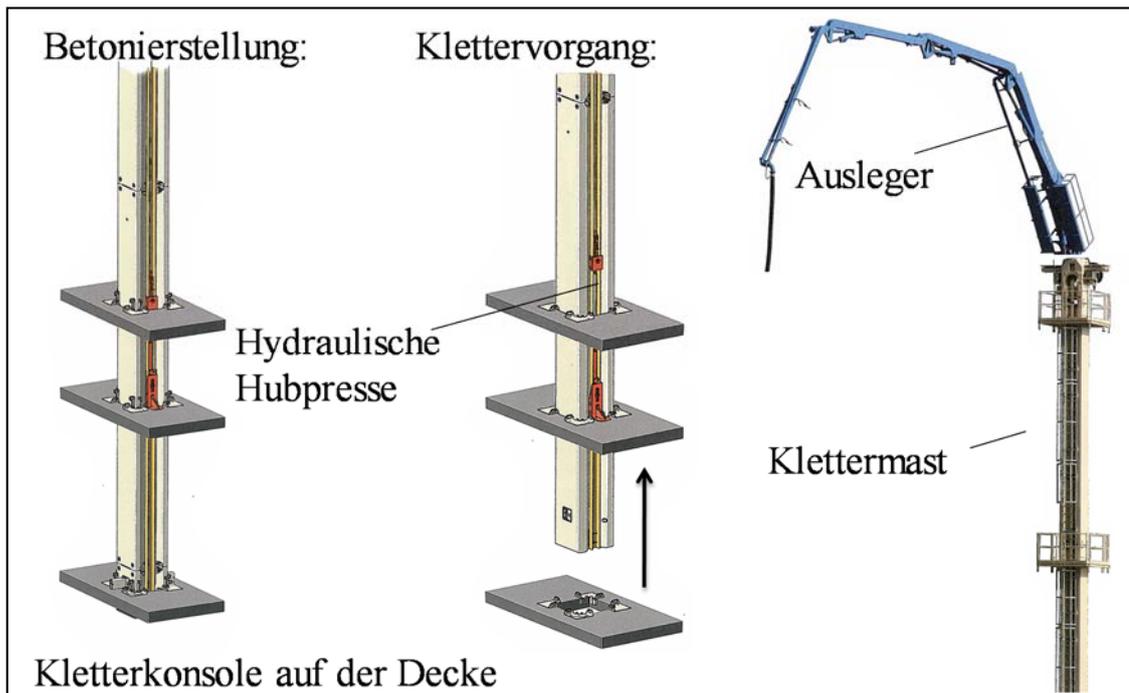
Kletter-Betonverteiler im Hochhausbau
